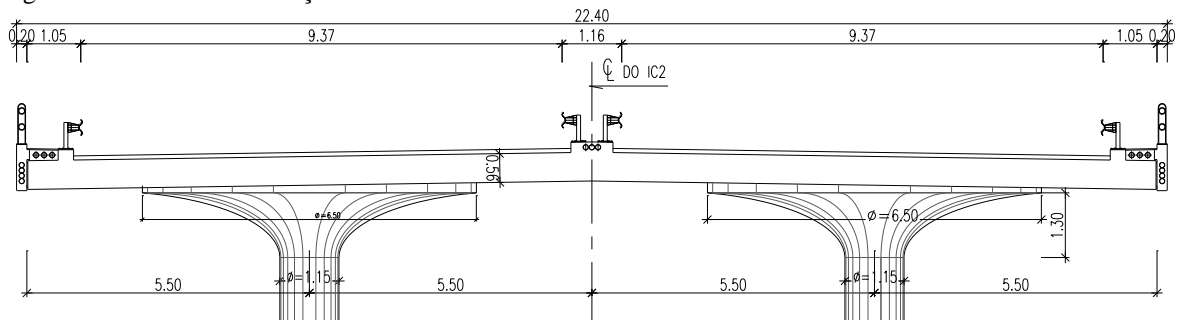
Secção transversal tipo do IC2 – 2 faixas de circulação.
